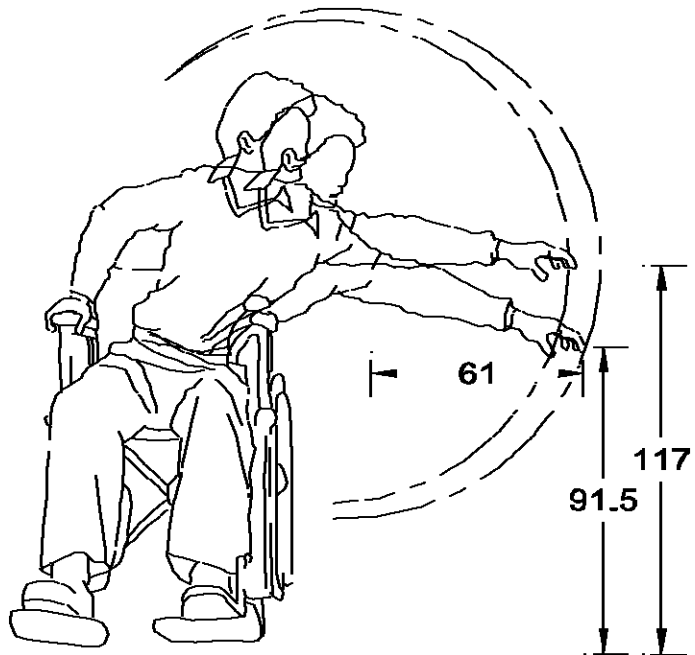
VISTA SAGITAL IZQUIERDA (ALZADO LATERAL)
